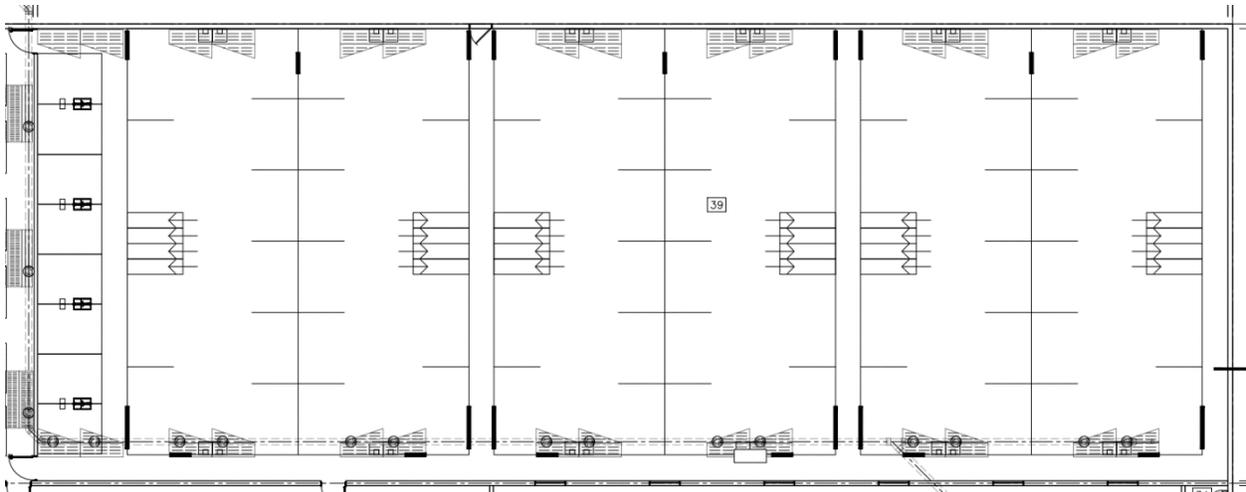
Plan de plancher de la salle de gestation en groupe (63'-6" x 167'-2")
